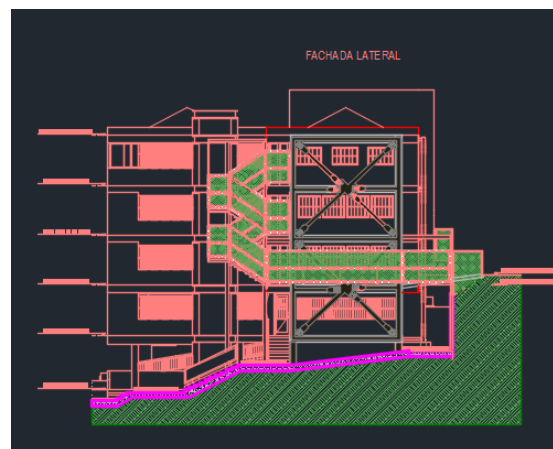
Reforzamiento estructural y escalera de emergencia
